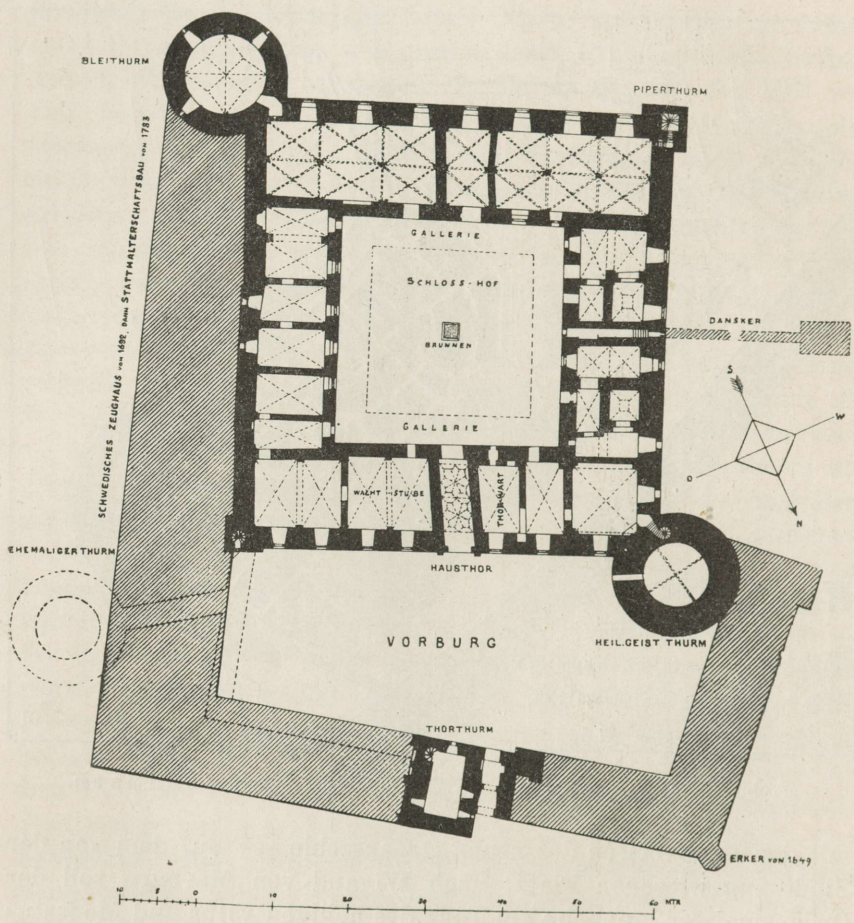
Grundriss des ersten Stockwerks des Schlosses. Nach Neumann.
